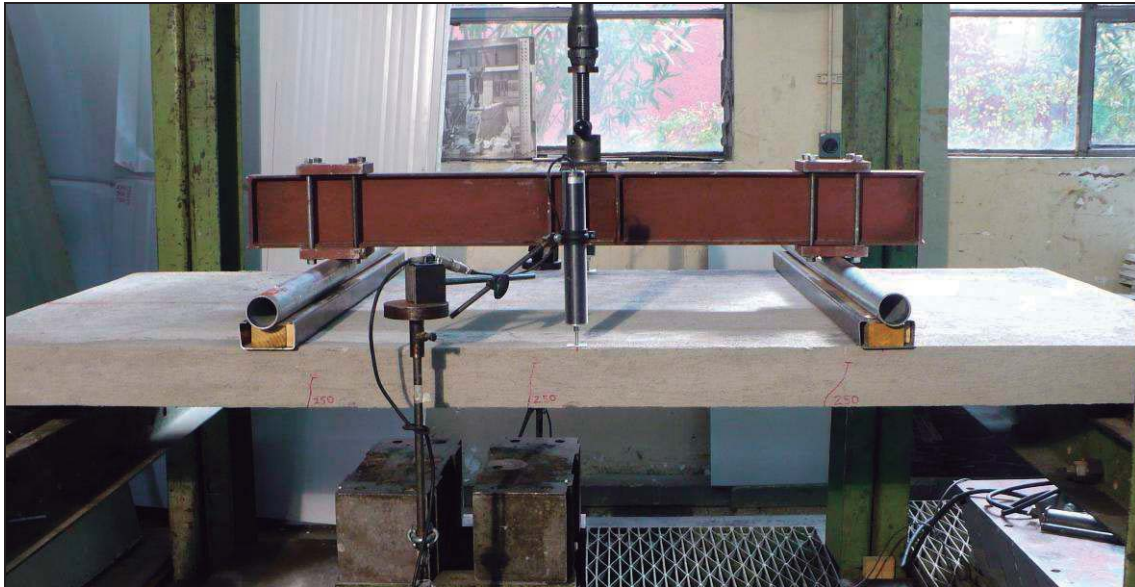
Vista general del montaje del ensayo de flexión al panel.
